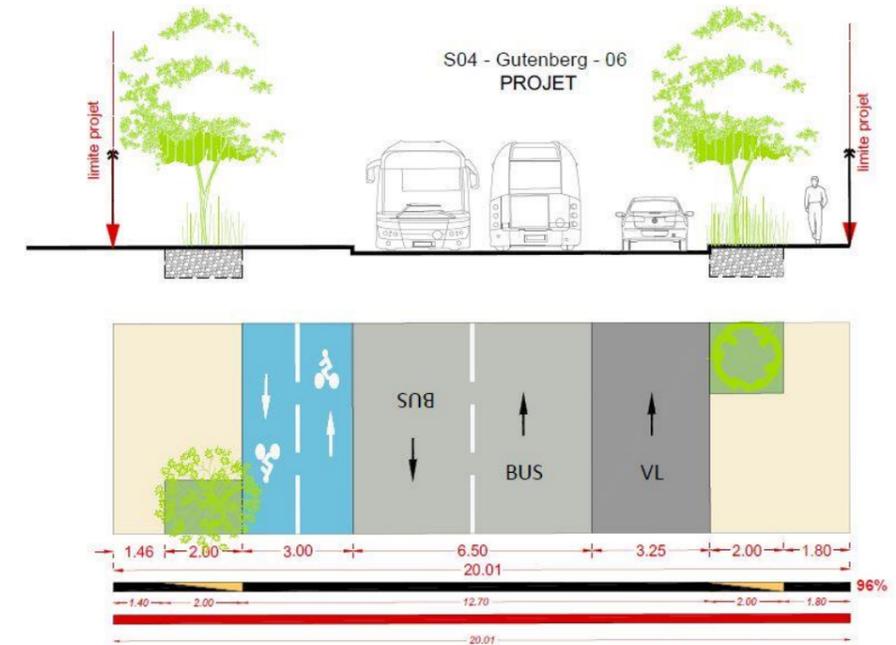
Profil projeté sur la variante B - rue Gutenberg
